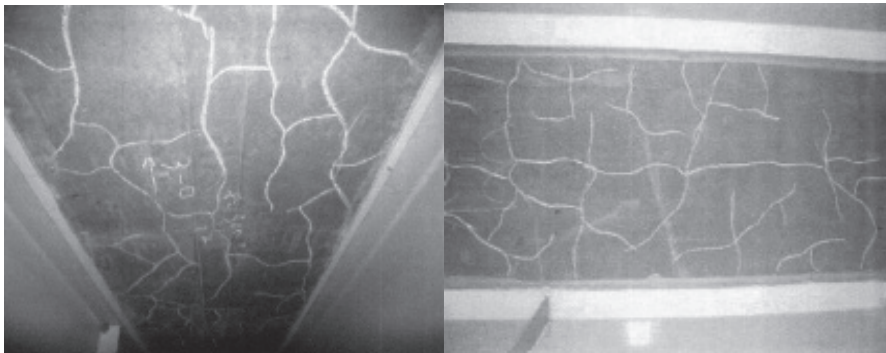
コンクリート床版に発生したひび割れ
